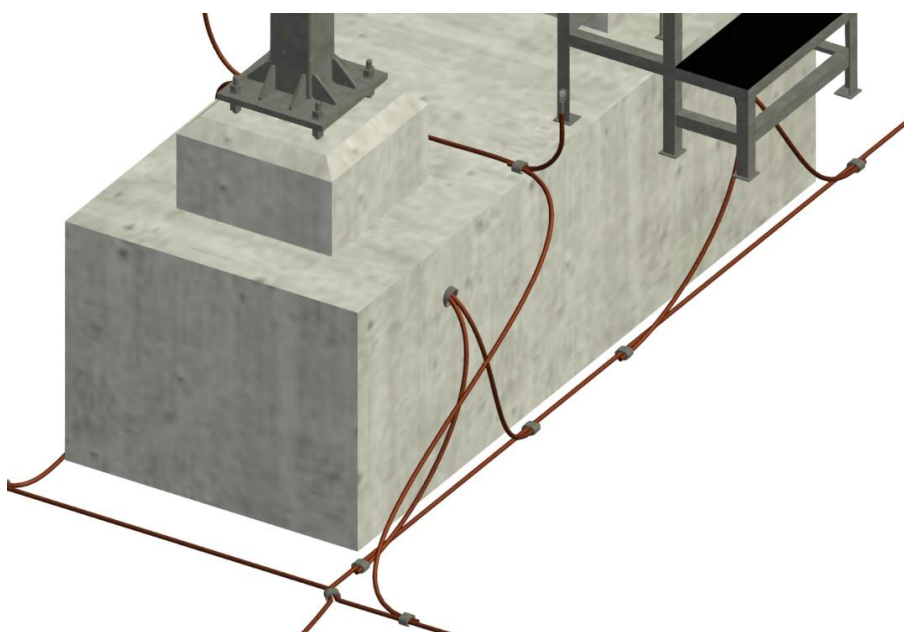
Ligações da rede de terras à fundação, às estruturas metálicas e ao banco de equipotencialização
